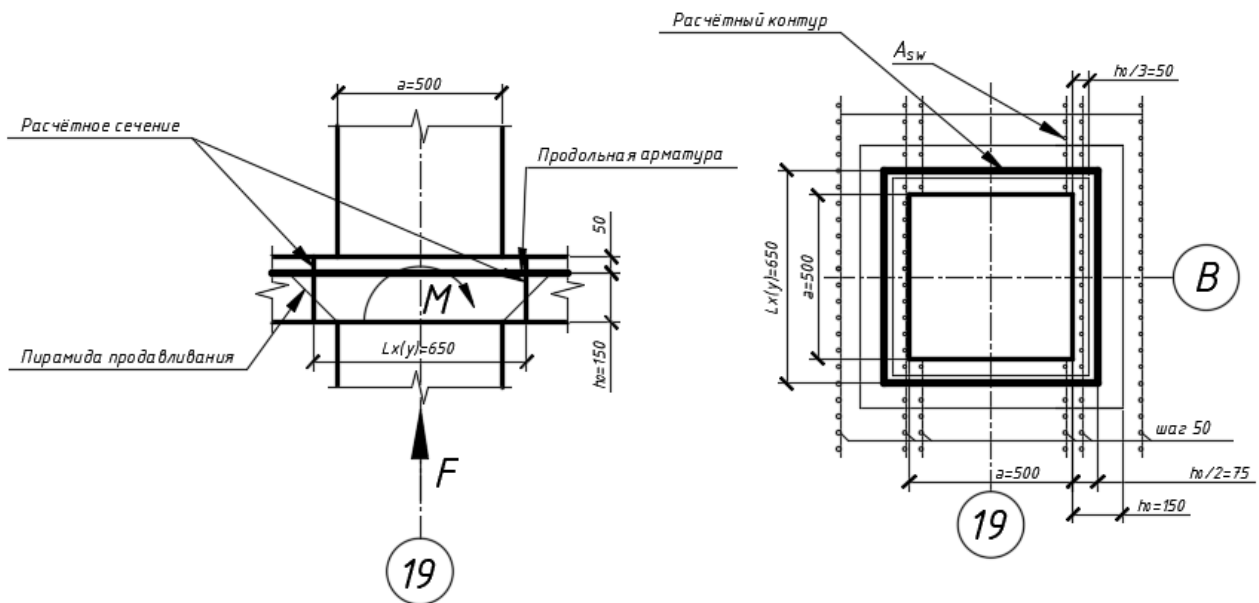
Расчетная схема продавливания перекрытия колонной
